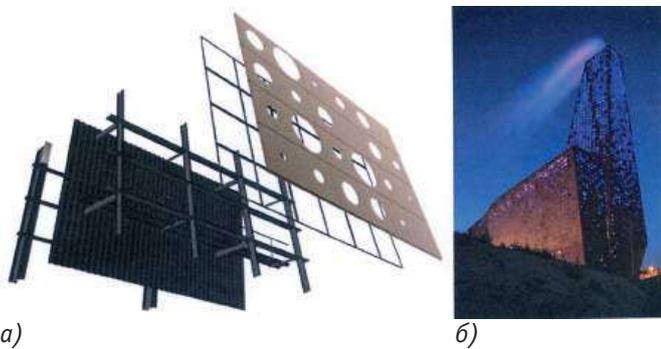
Мусоросжигательный завод в Роскилде: а) схема решения фасадов; б) общий вид
